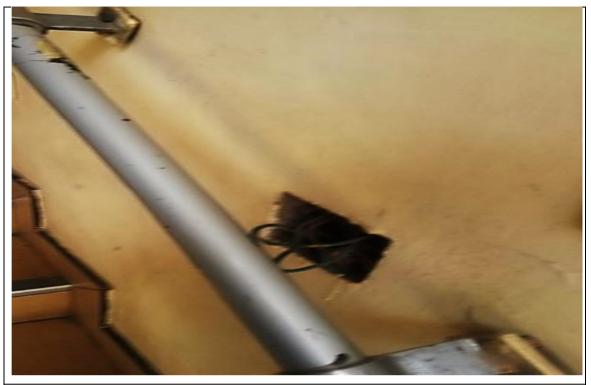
Imagen donde se muestra la ventilación obstruida del baño del segundo nivel.
